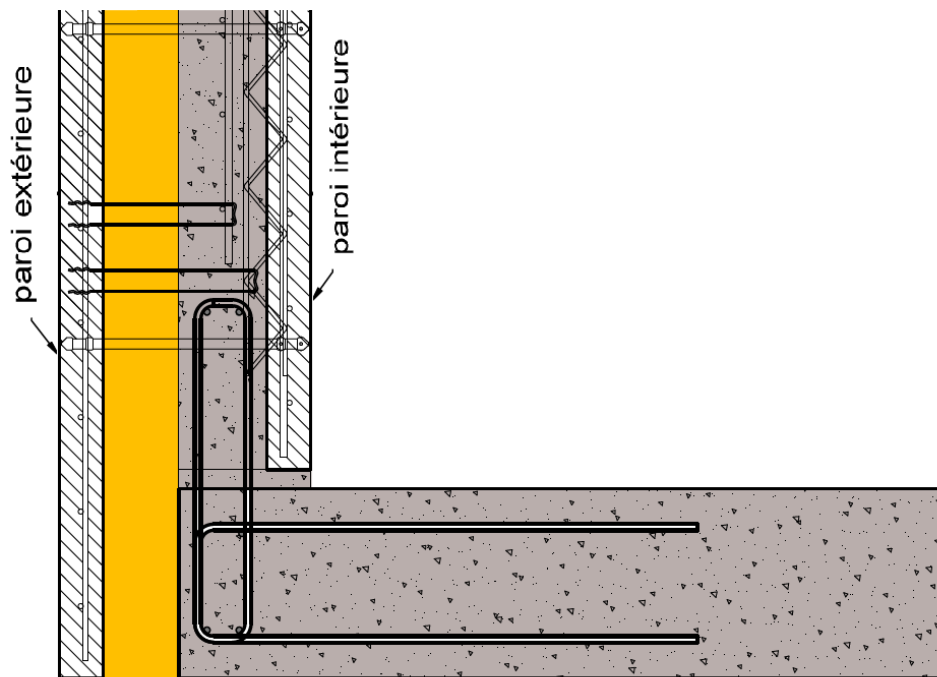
Mur 2000+ COMFORT sur une dalle porteuse
